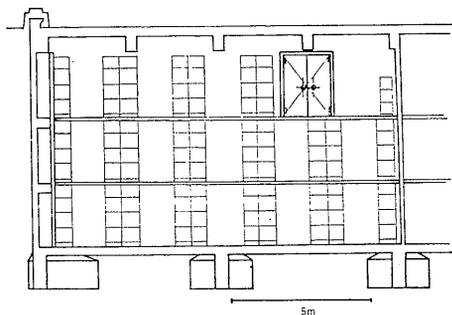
恒温恒湿特別収蔵庫断面図 縮尺1/100
